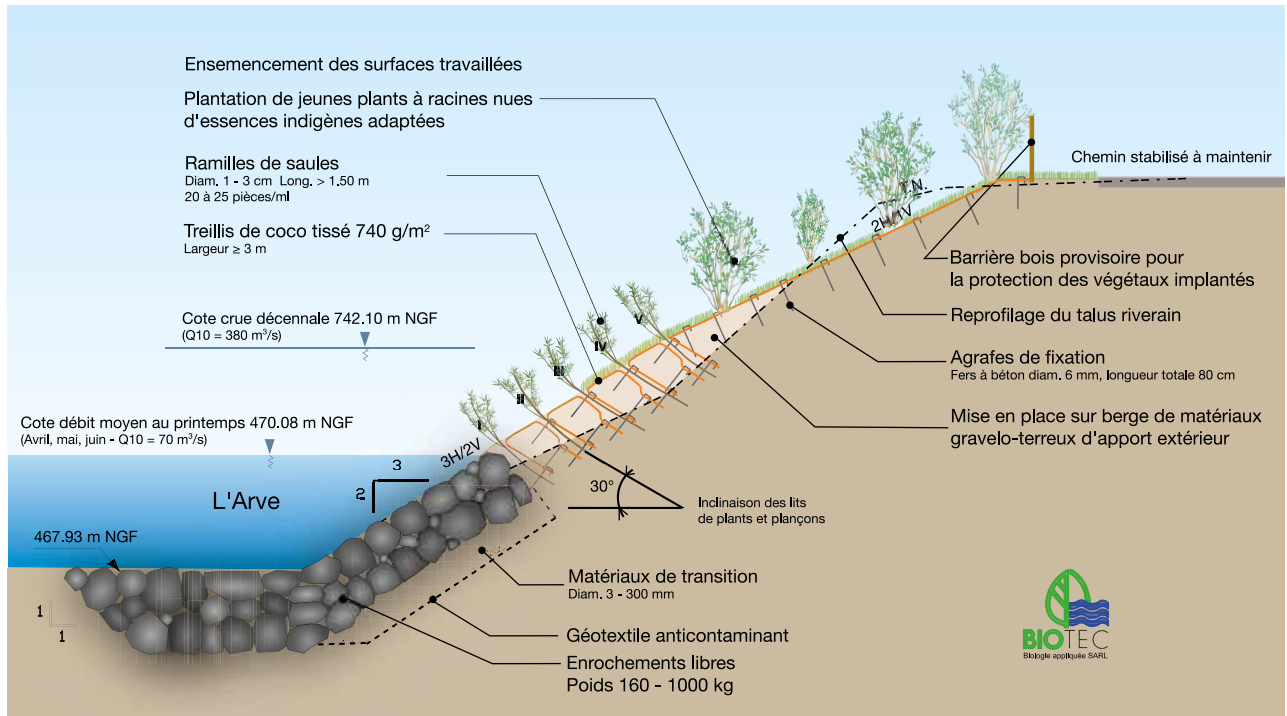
Coupe transversale sur l'ouvrage (aménagement de type B).
